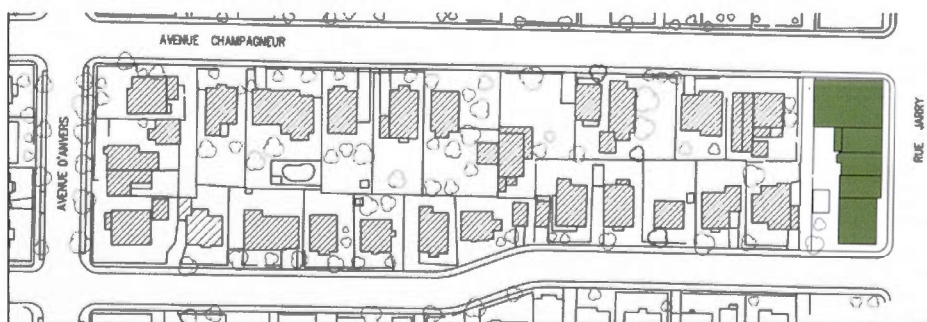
Site plan proposé pour îlot n° 21, par Fatemeh Rafiei, 2011
